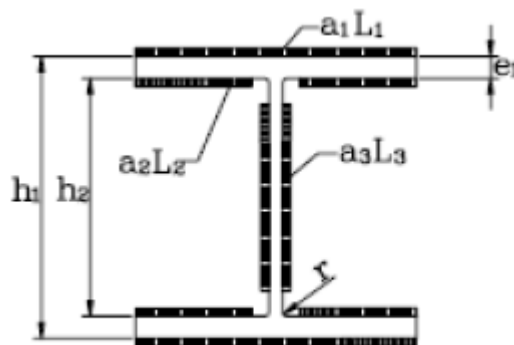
85. Predimensionamiento de los cordones de soldadura
